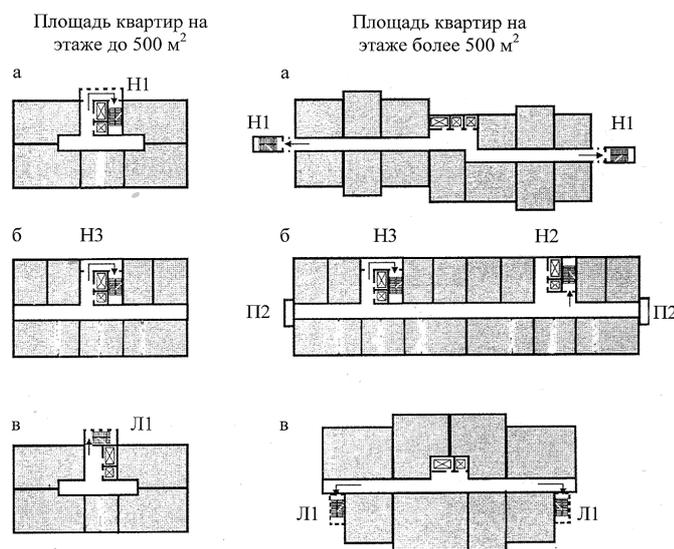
Схемы планировочных решений путей эвакуации: а – через закрытые лестницы с проходом через наружную зону; б – незадымляемые лестницы с подпором воздуха; в – лестницы с открытыми или остекленными проемами
